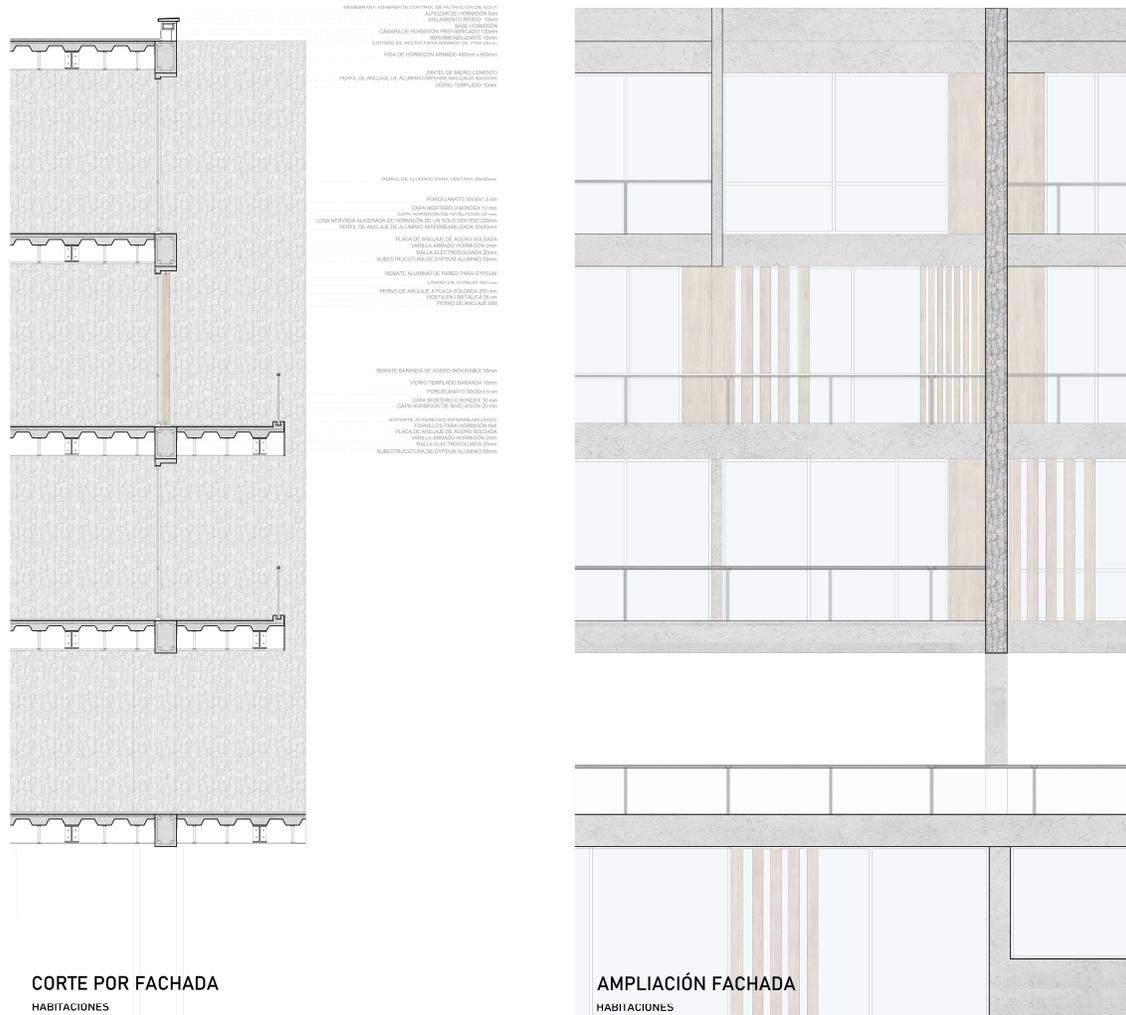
Corte por Fachada 1/ Resolución Constructiva. Elaboración propia.
